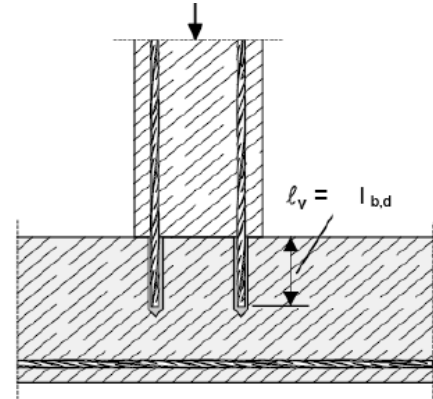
Połączenie słupów zginanych lub ścian fundamentowych z płytą fundamentową
